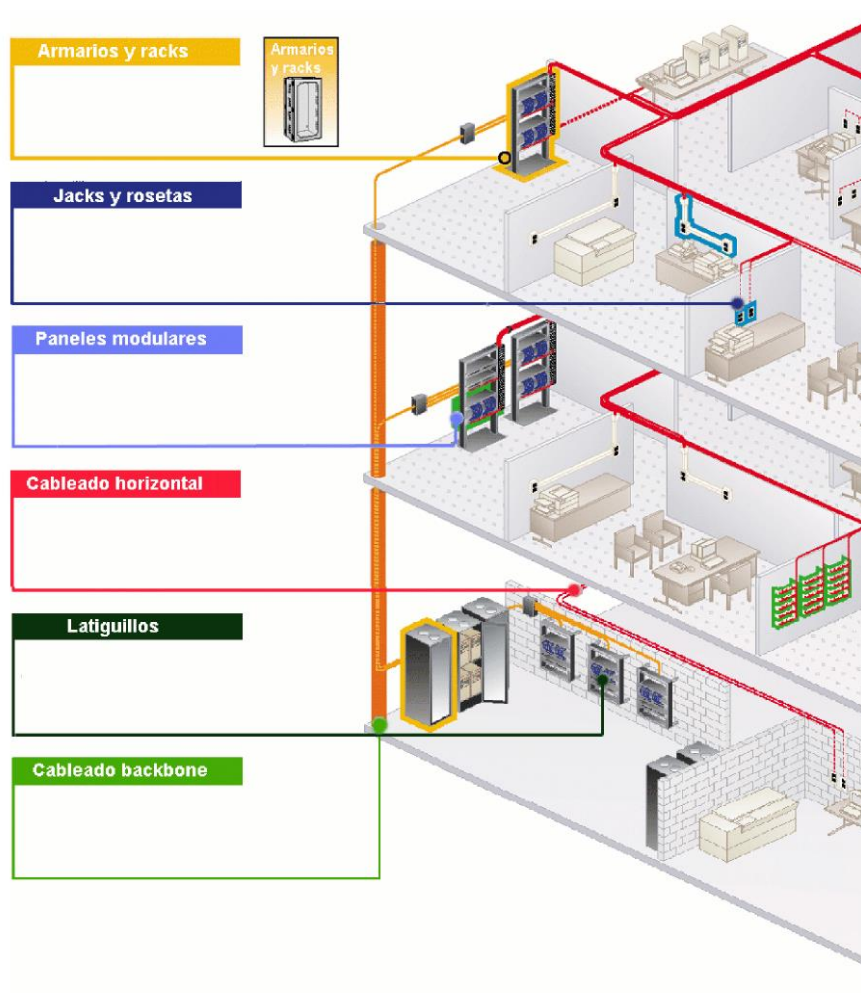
Cableado Horizontal y Vertical usando Cross-Connect.
